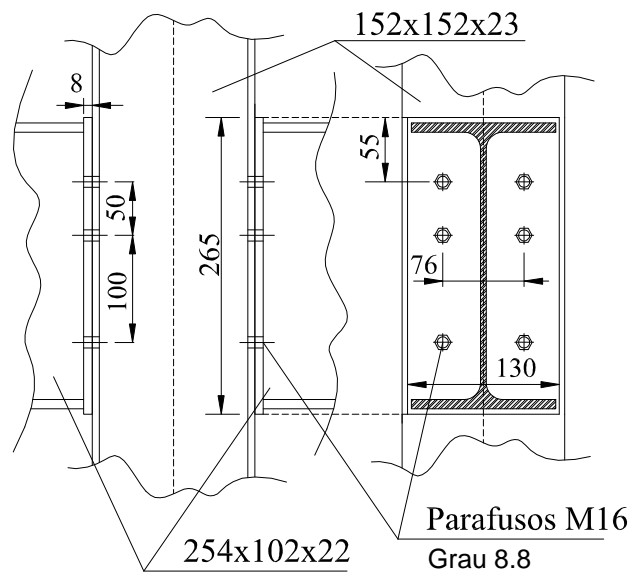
Detalhamento da ligação proposta (AL-JABRI *et al.*, 2005) (dimensões em mm)
